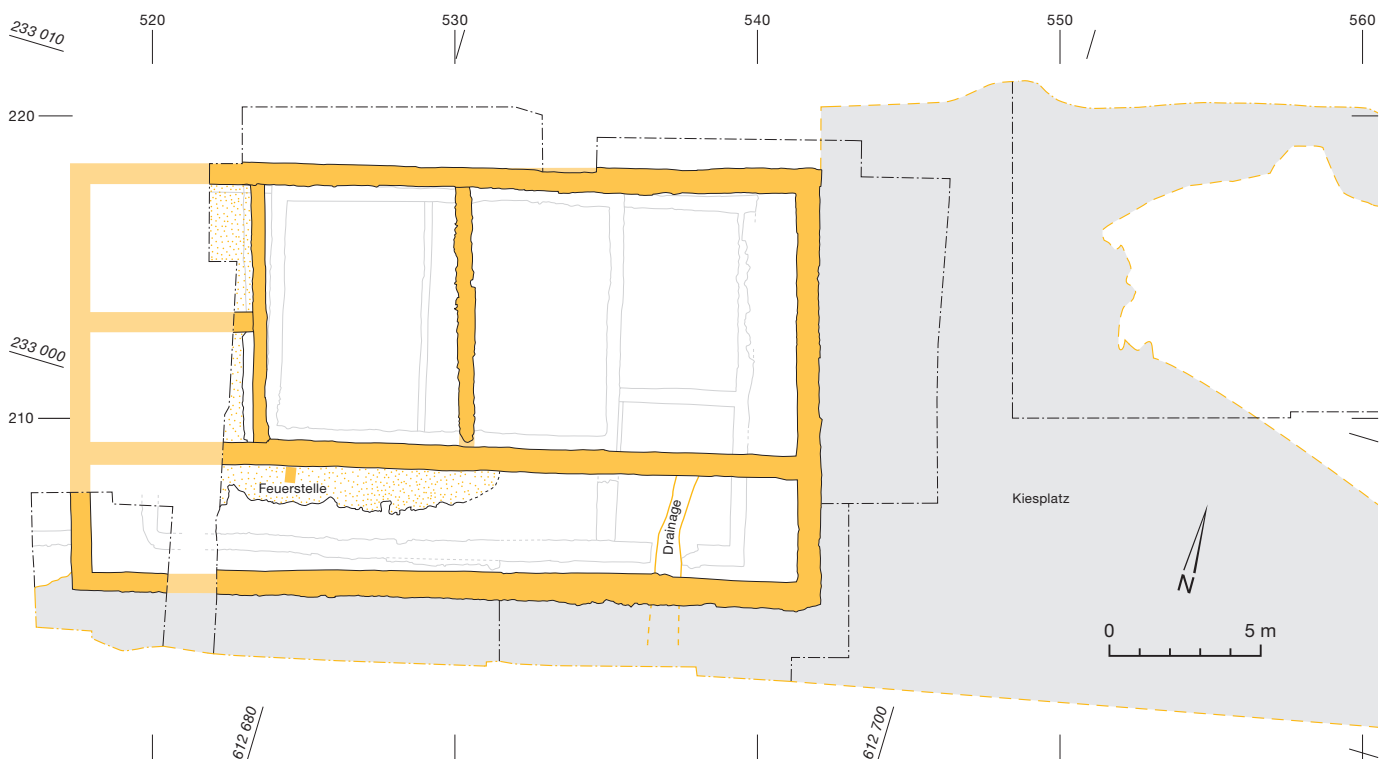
Attiswil, Leimenstrasse 15. Grundriss mit späteren Umbauten. M. 1:250.
